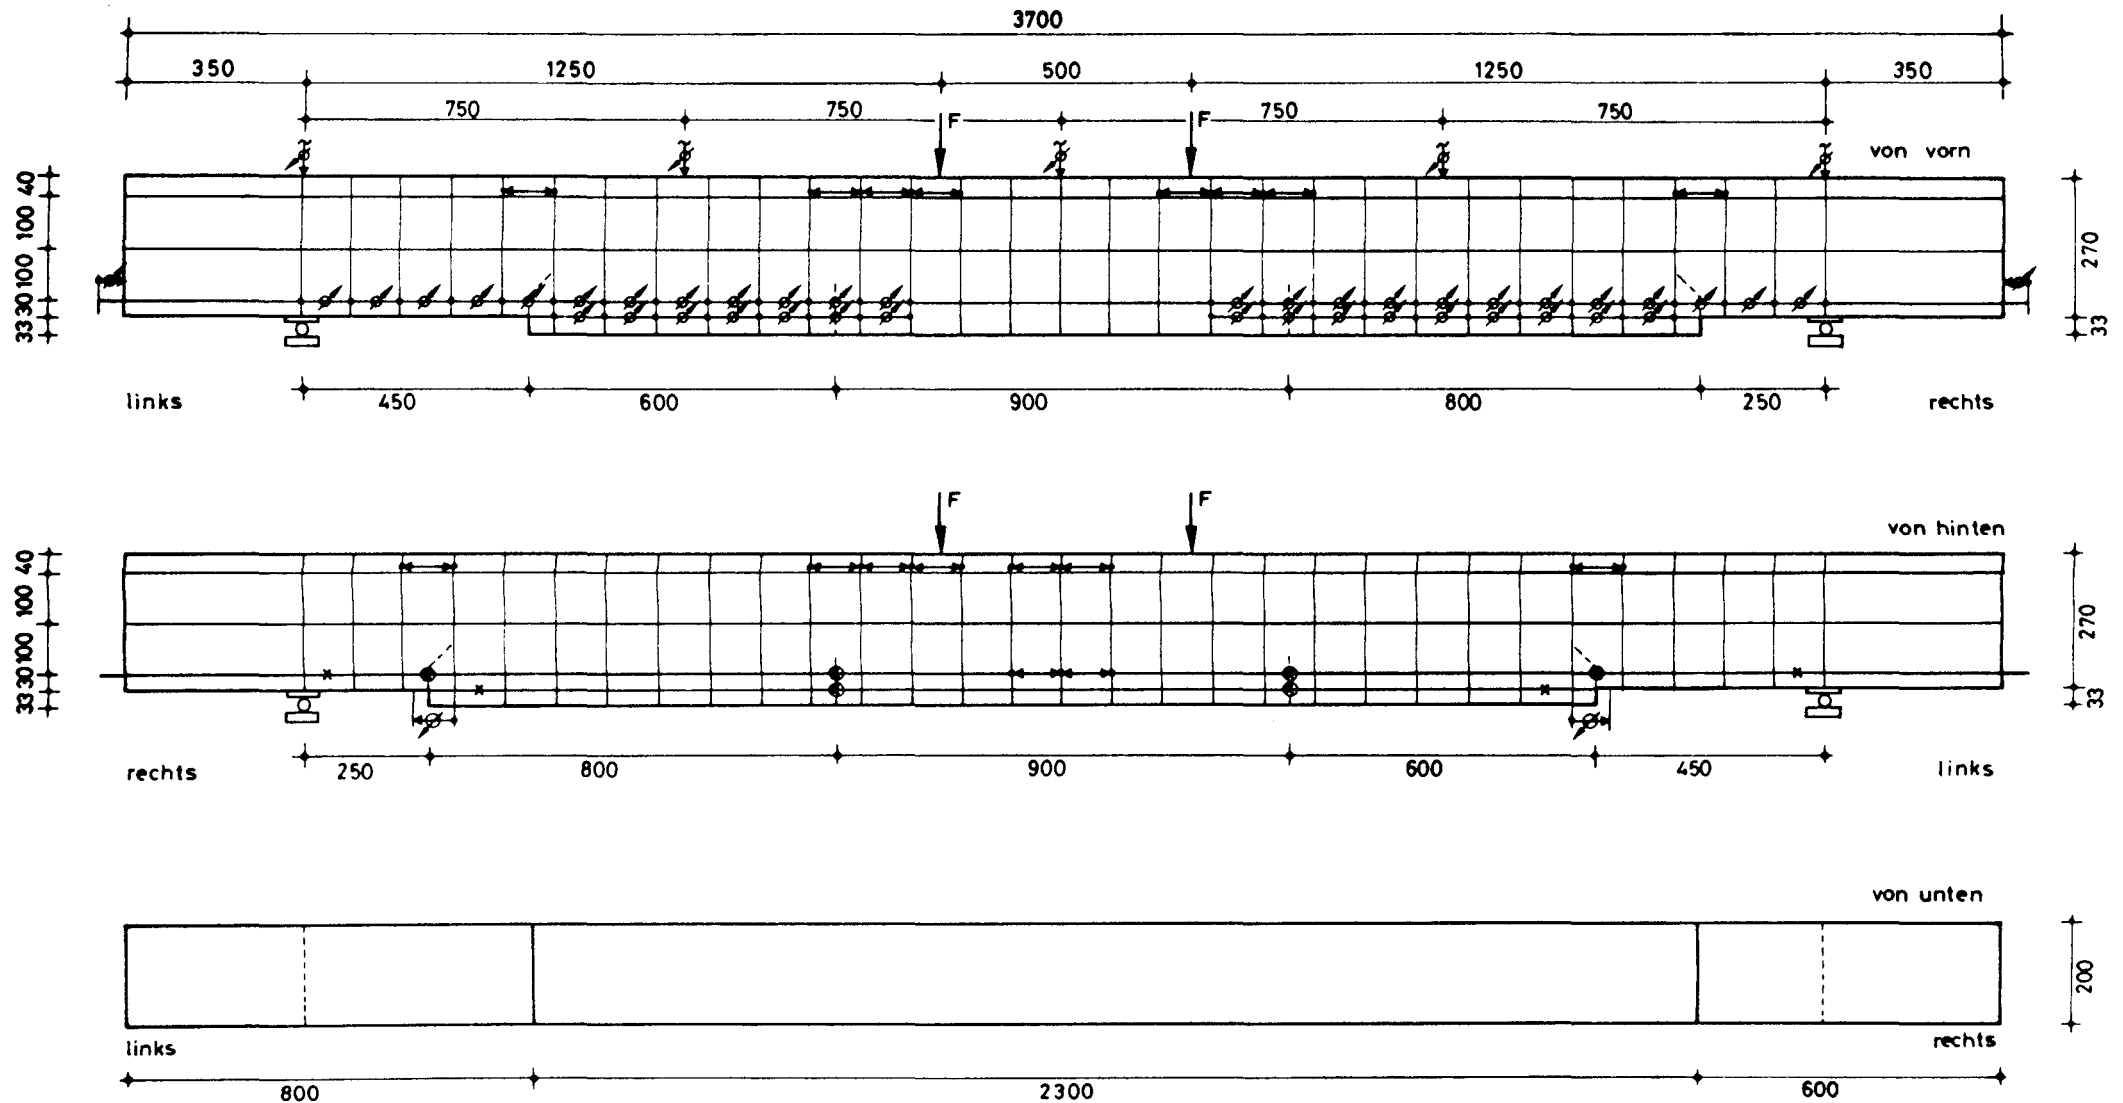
Laststufenplan — Balken SB06, Lastfall I (LF1)
